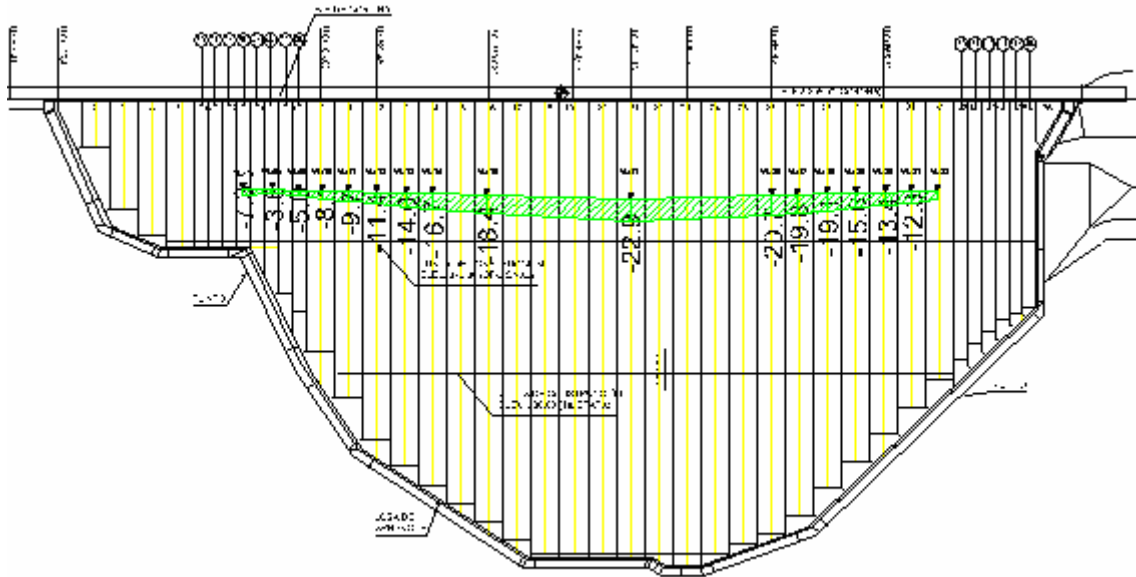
Asentamientos en cara de concreto. Elev. 327.
